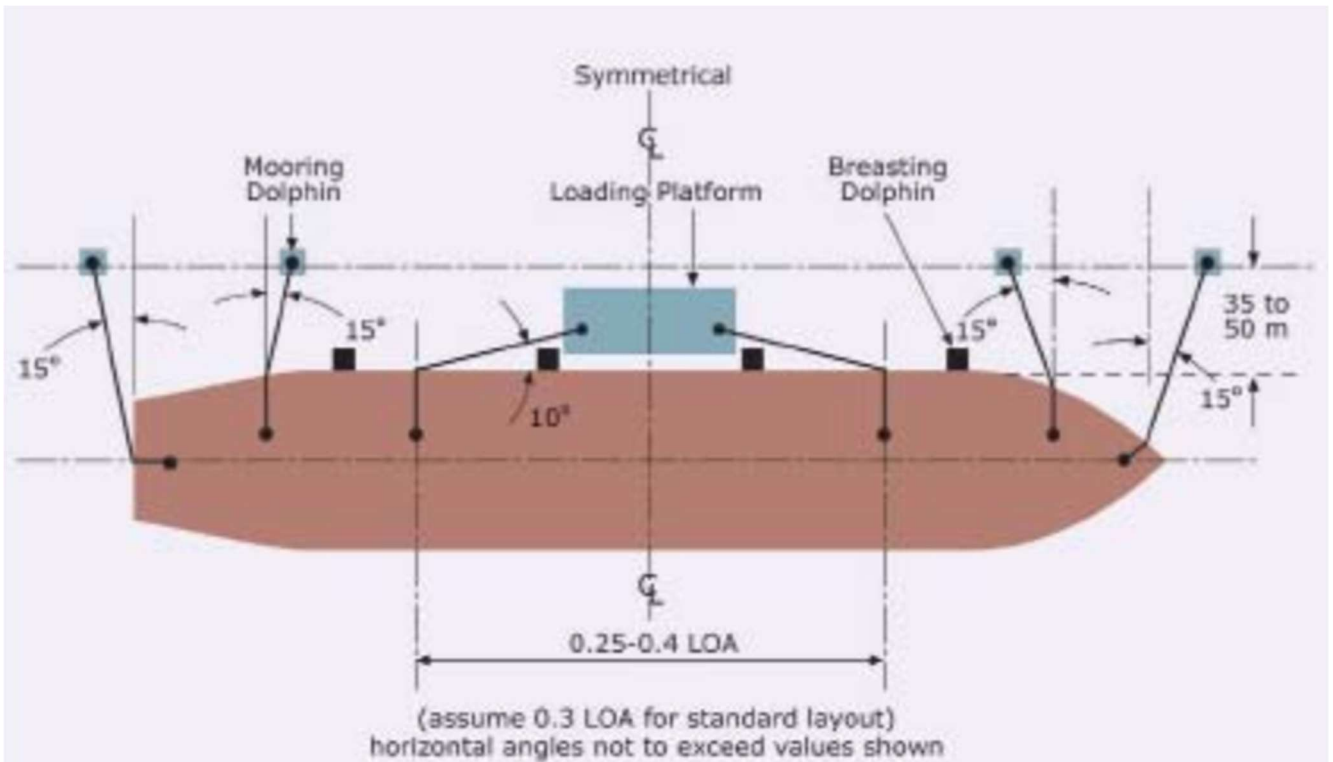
Layout de amarração – estruturas discretas – OCIMF (2008)
